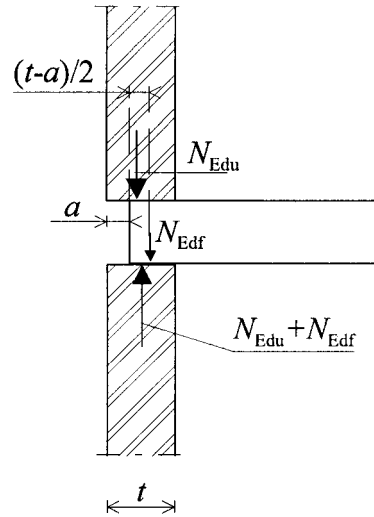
Diagramme illustrant les efforts appliqués lorsqu'un plancher est soutenu par une partie de l'épaisseur d'un mur
